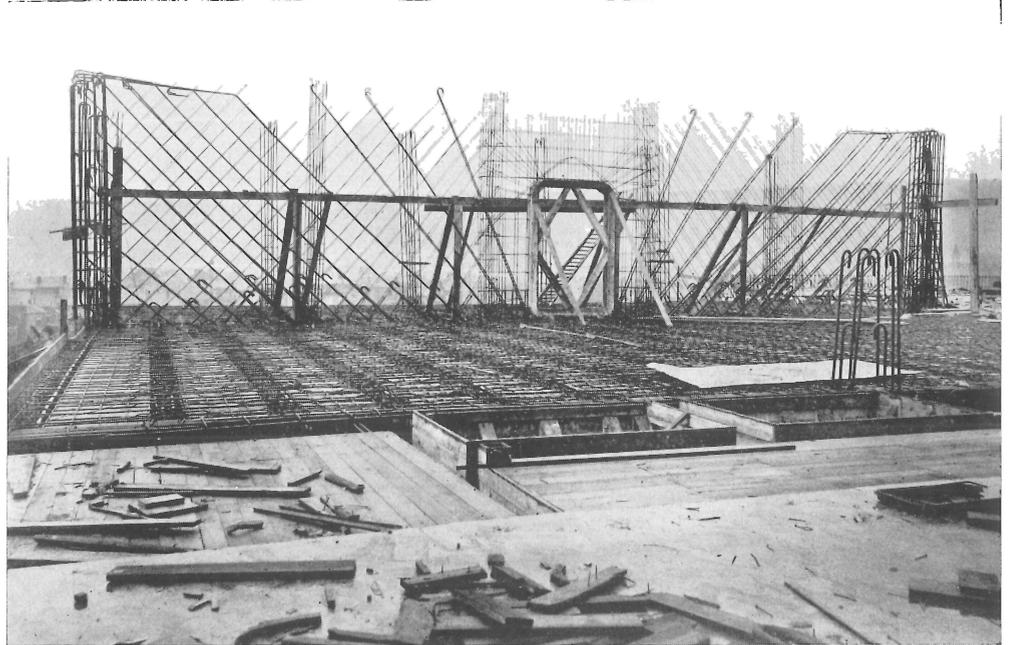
Armature de la poutre en béton armé de 20 mètres de portée, à évidement central.
